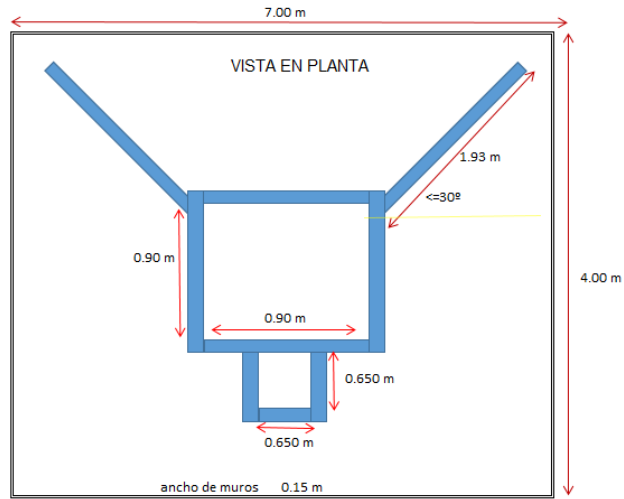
Pre dimensión hidráulica en planta de la cámara húmeda 2
